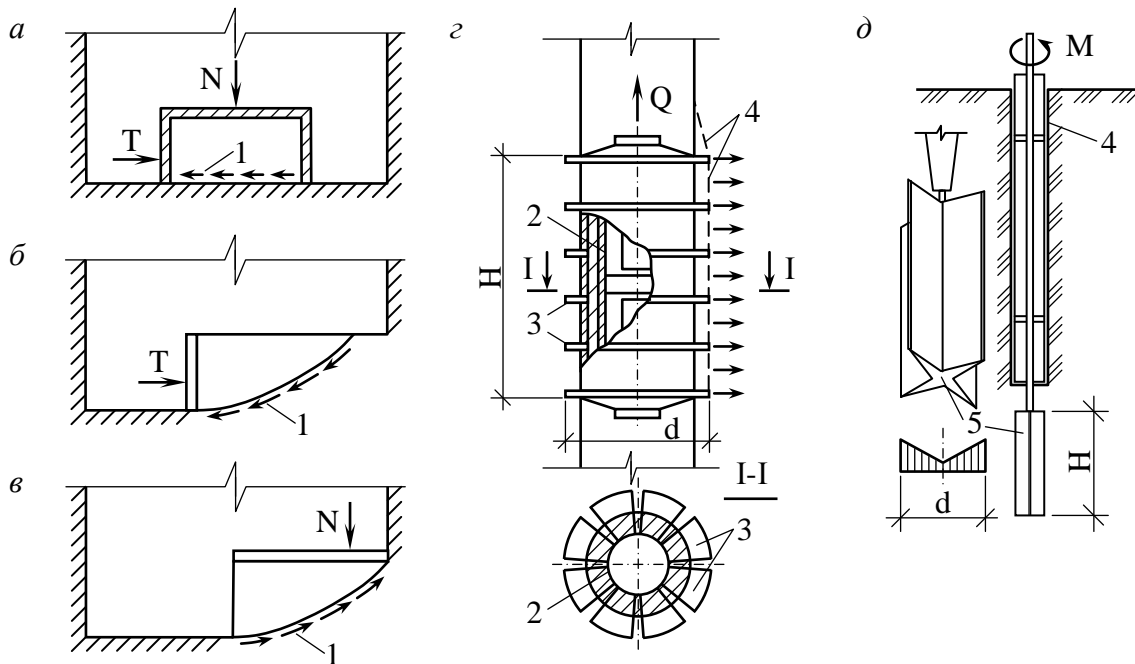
Схеми польових установок для випробувань на зрушення: *a* – плоске зрушення; *б, в* – зрушення по наперед заданій поверхні методами випирання та обвалення притулених призм ґрунту; *г, д* – зрушення в свердловині пресіометром зрізу та крильчаткою; 1 – поверхня зрушення; 2 – камера пресіометра; 3 – жорсткі поздовжні зрізувачі; 4 – свердловина з обсадною трубою; 5 – крильчатка на жорсткій штанзі
